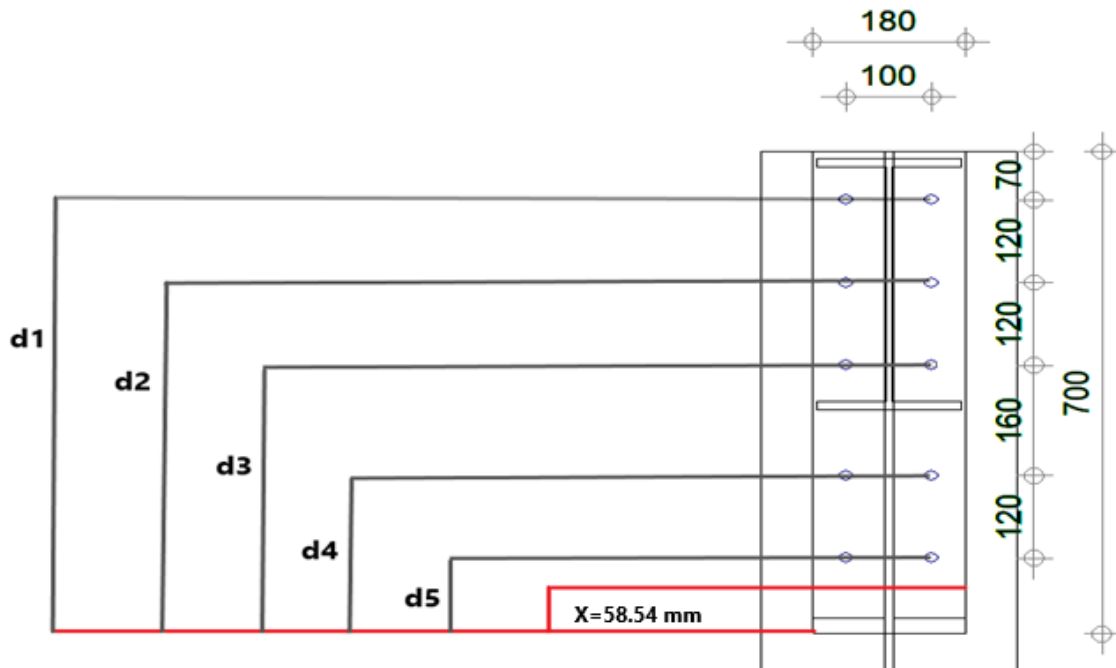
la hauteur de la zone comprimée (Assemblage poteau-traverse).
